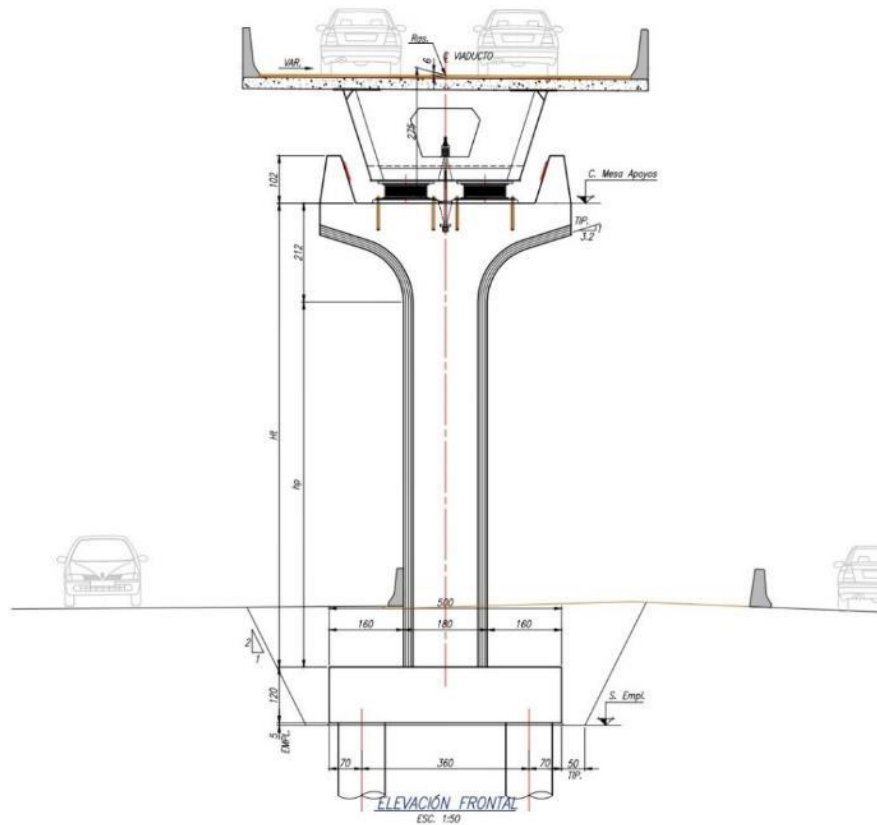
5 Elevación Frontal cepa (Astaburuaga, 2020)
